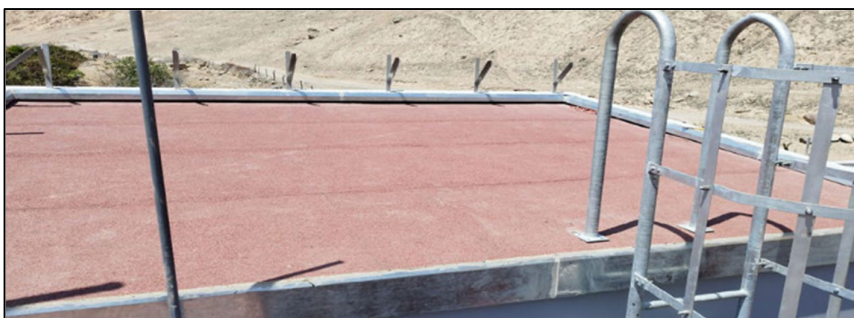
Colocación de manto asfáltico en losa de aligerada
